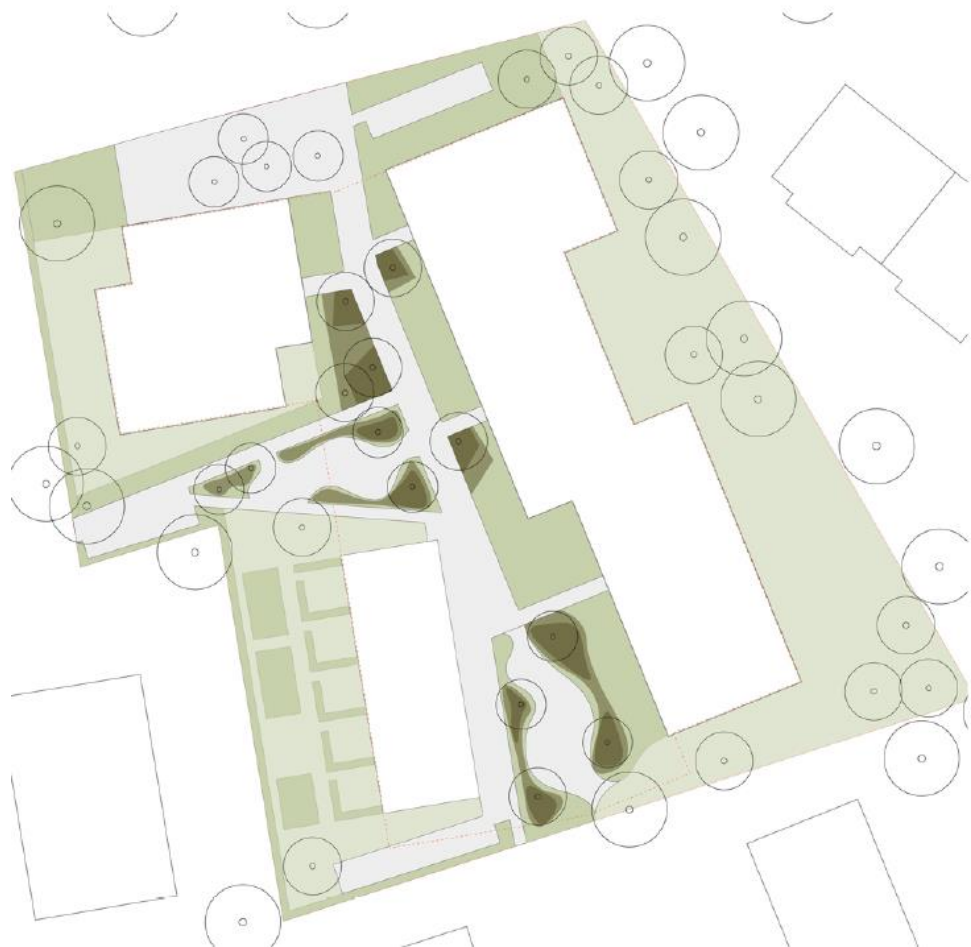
Punktueller Erhebungen für Baumpflanzungen auf Tiefgarage (in dunkelgrün)
